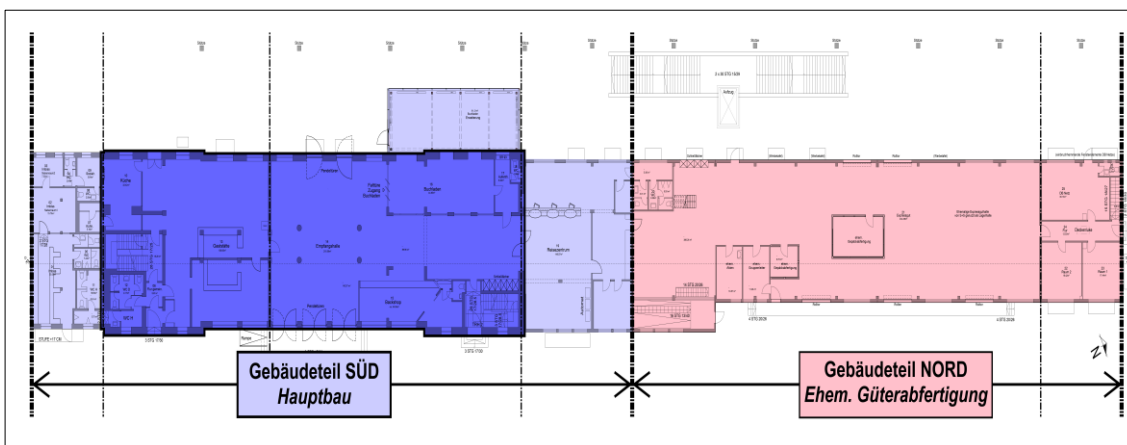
Gebäudeteil SÜD mit mehrgeschossigen Baukörper (dunkelblau) und NORD mit erdgeschossigen Baukörper (rot).
